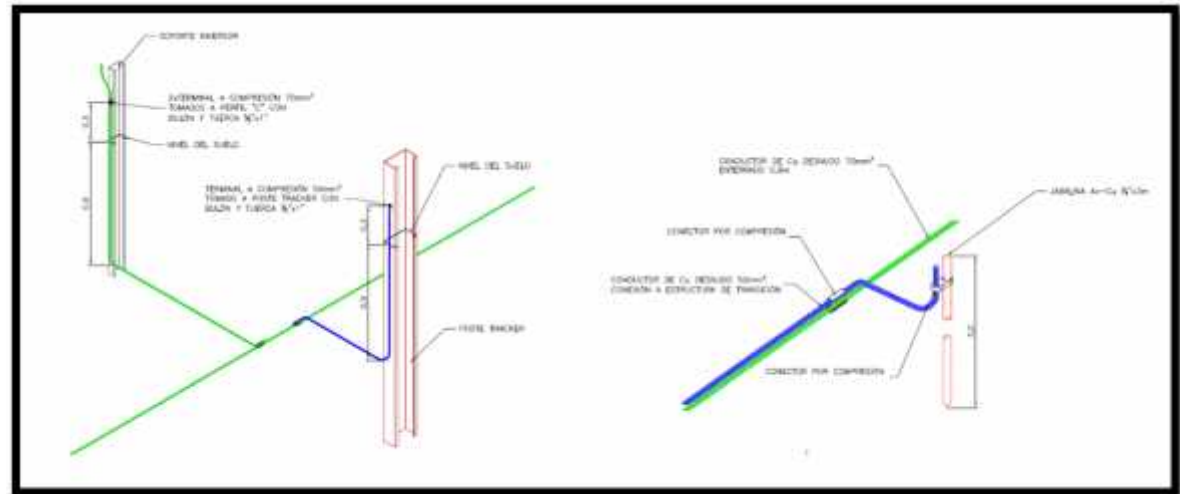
Detalles Tentativos de vinculación de Trackers a PAT
